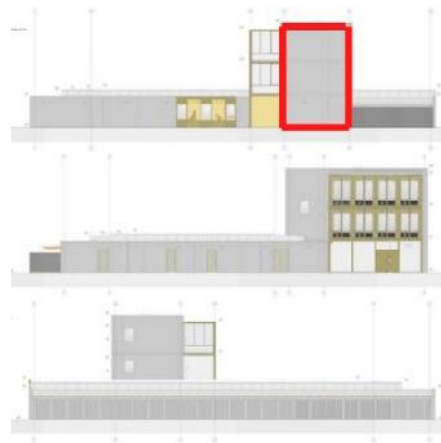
Fachadas Refugio de animales y crematorio de mascotas Lommel Bélgica
